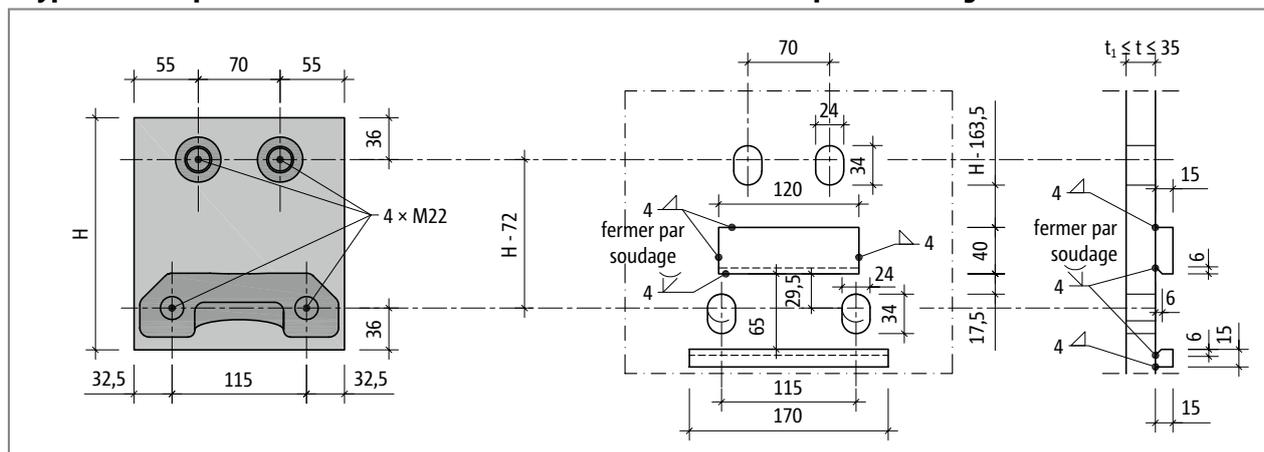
Schöck Isokorb® T type SK-MM2 : construction de la connexion de la plaque frontale ; trous ronds en bas, ou trous oblongs et deuxième taquet pour transférer l'effort tranchant négatif
